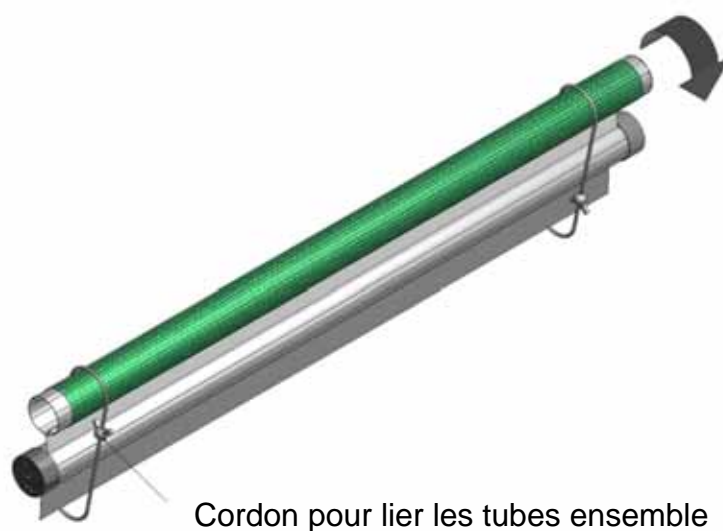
, Enroulez la porte autour du tube supérieur et fixez
